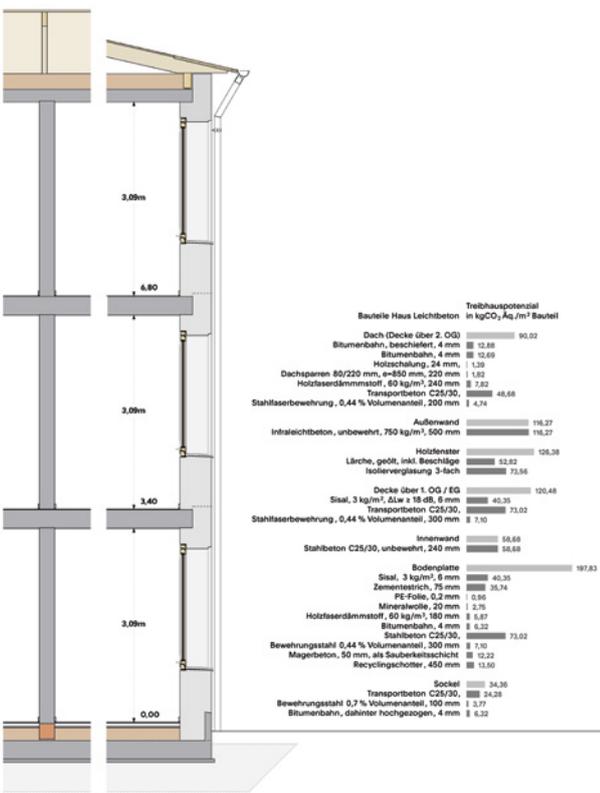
Haus Leichtbeton: Detailschnitt und Treibhauspotential der Bauteile
